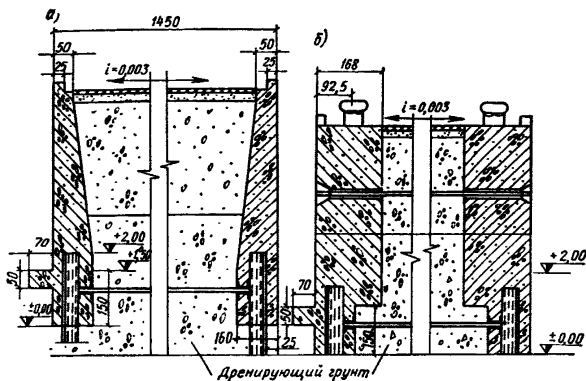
Виды причальных стенок стального шпунта с железобетонными оголовками, находящимися в зоне переменного уровня воды а — без кнехтов; б — с кнехтами
